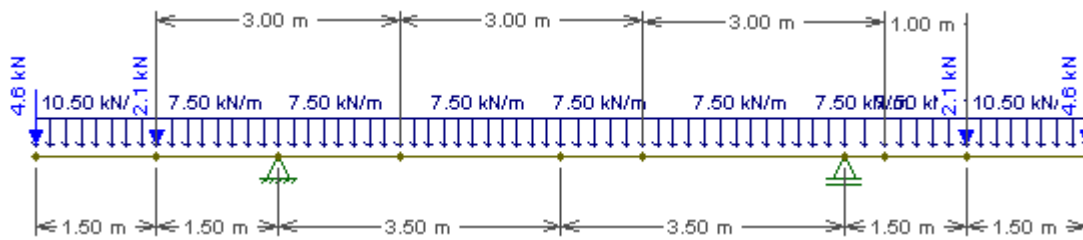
1 - Aplicação das cargas permanentes na secção transversal
